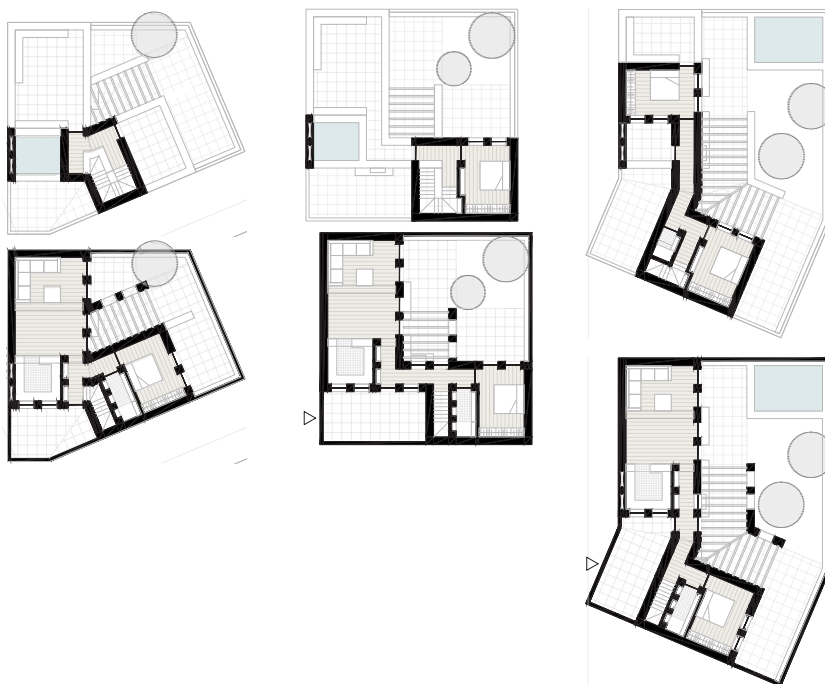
Plantas dos módulos de gaveto turísticos 1:500
